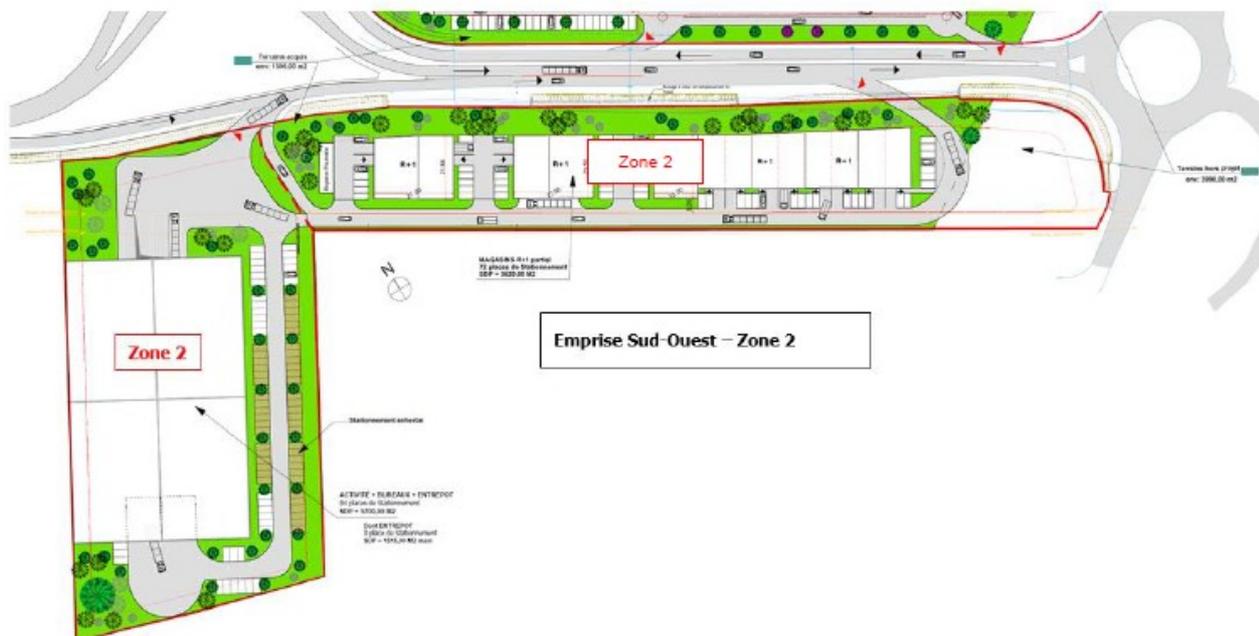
Plan d'aménagement de la zone d'activités (Source : Étude d'impact – p.9)
